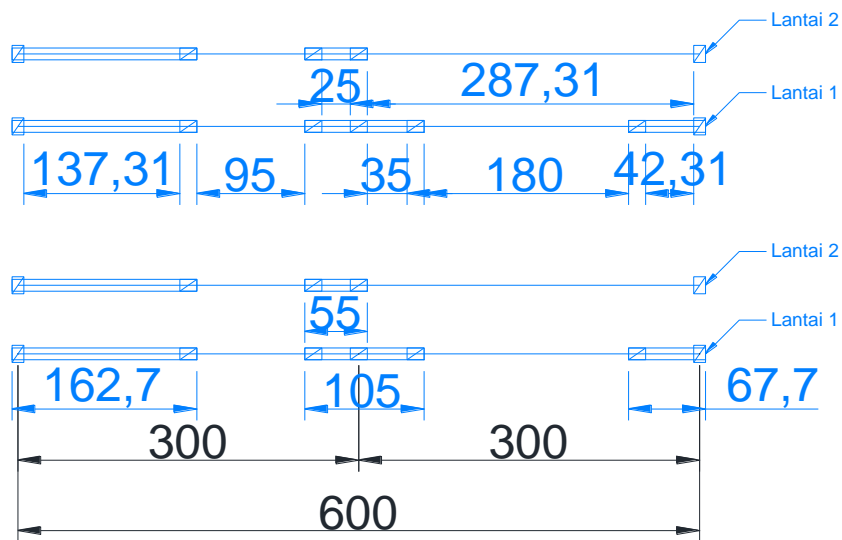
Denah model lantai 1 (kiri) dan lantai 2 (kanan)
